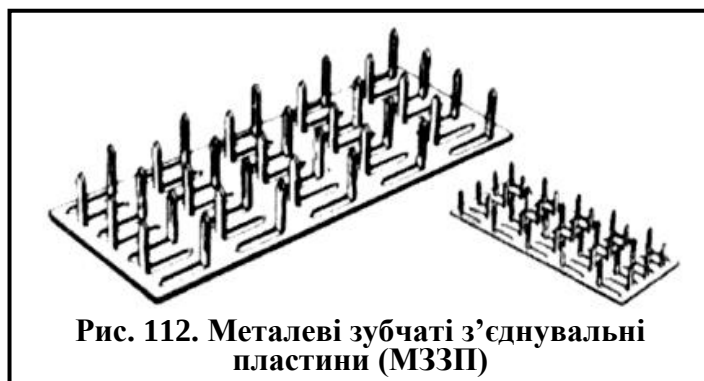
Металеві зубчаті з'єднувальні пластини (МЗЗП)
